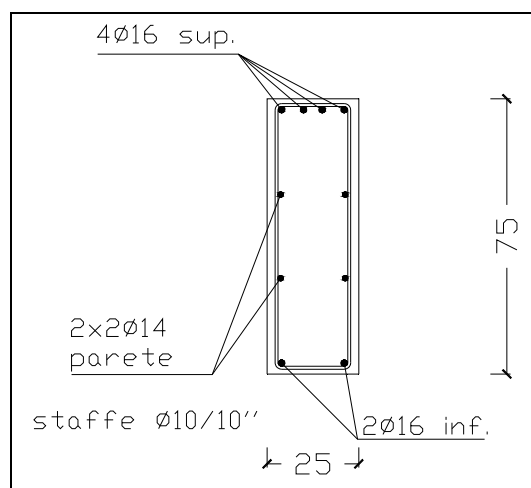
Sezione trave a ginocchio in corrispondenza del piano (misure in cm)
